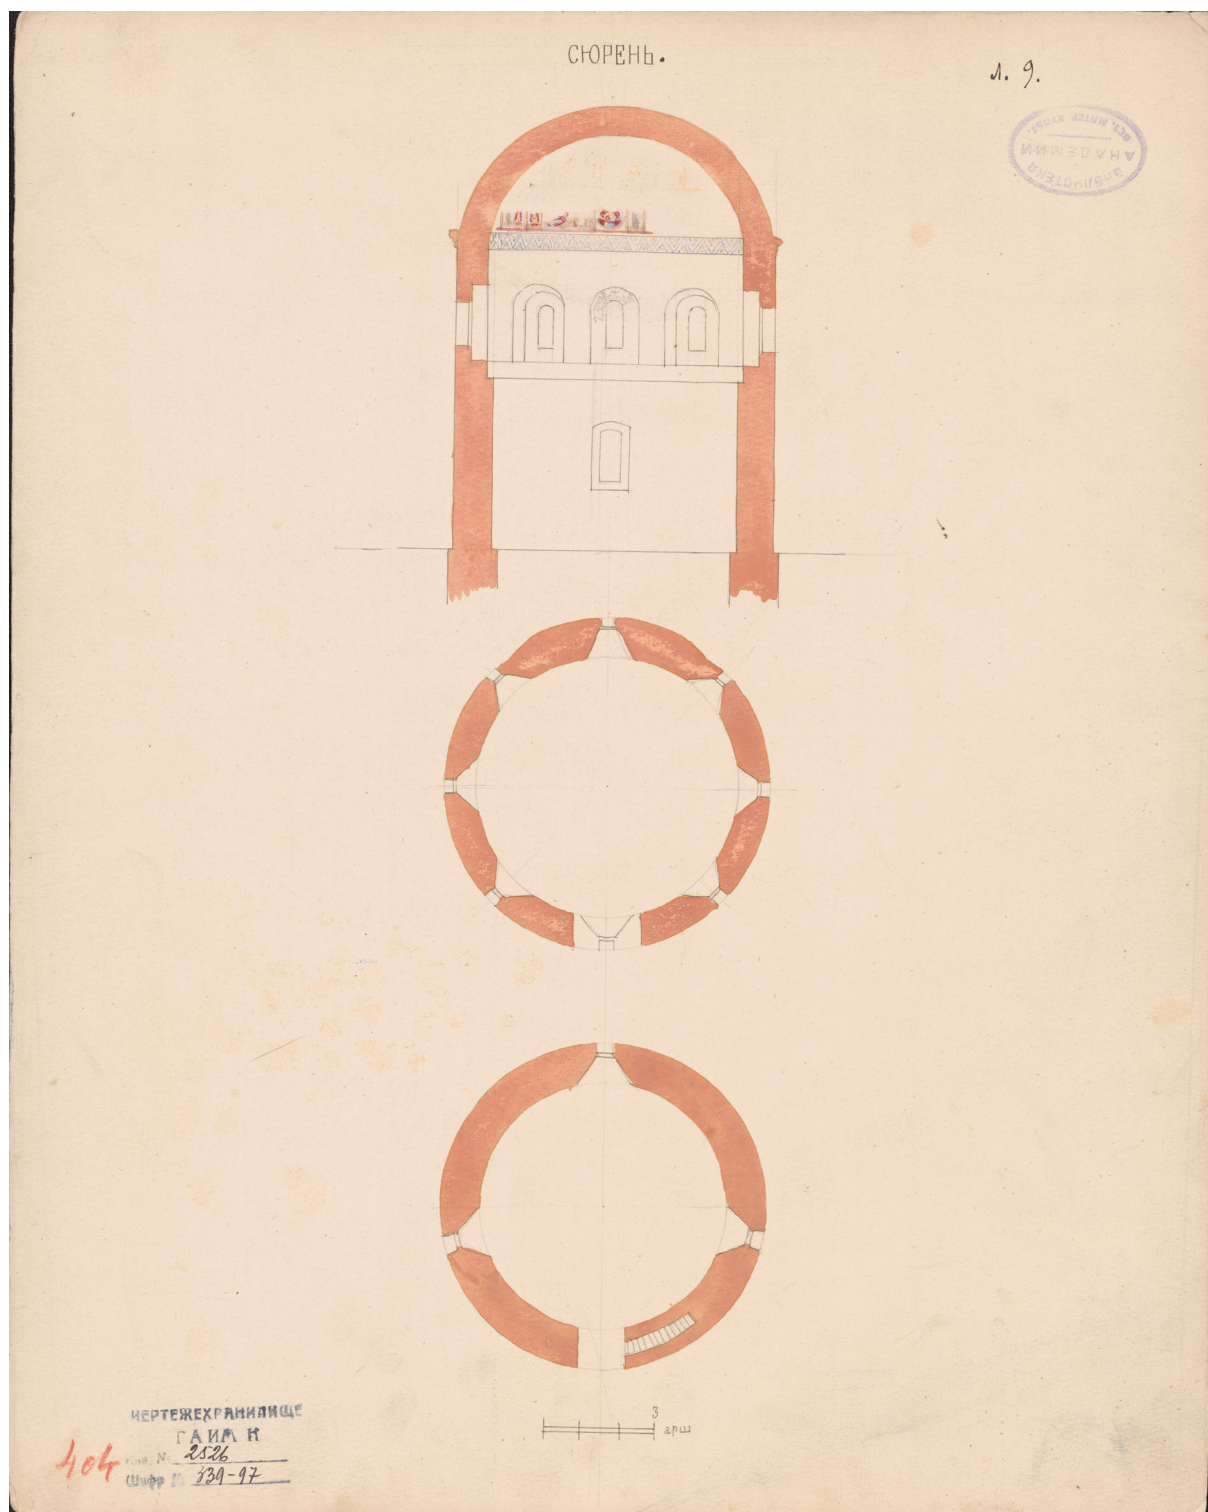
Планы и разрез Сюйренской башни по Д.М. Струкову
